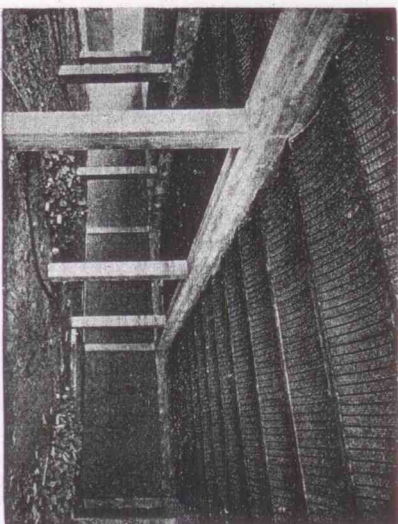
Lajes em abobadado, entre vigas de concreto armado.
